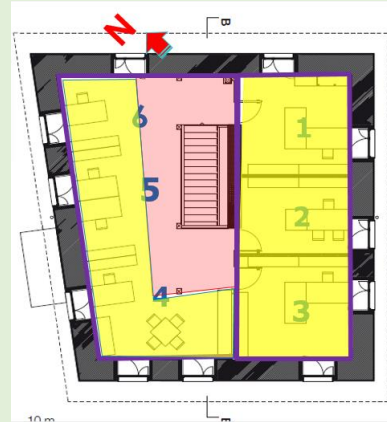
plan RDC de 2^{eme} exemple, MAGAZINE DE CHANTIER
